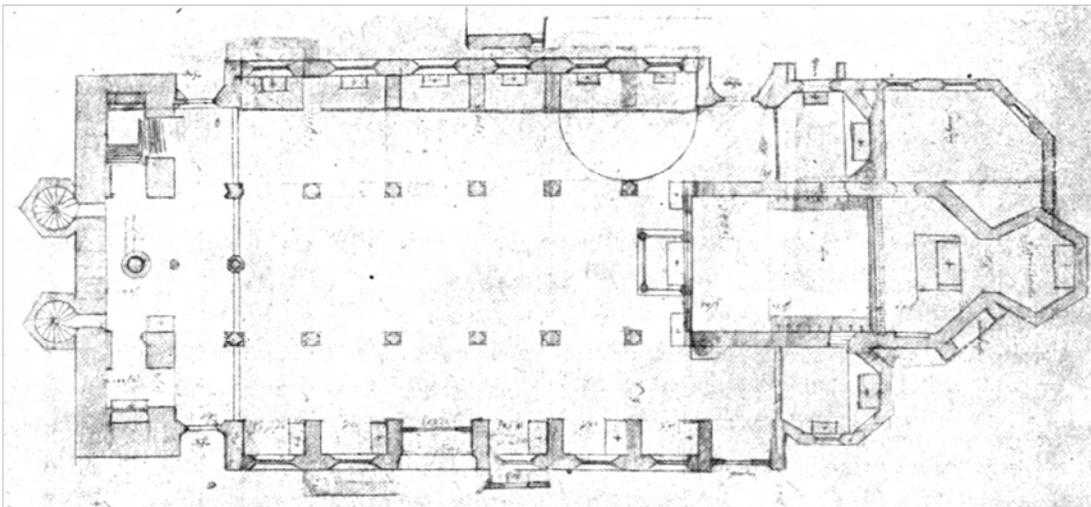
Issac Baader, Grundriss der St. Peterskirche, um 1630 (aus: HOFFMANN 1922, S. 28)
